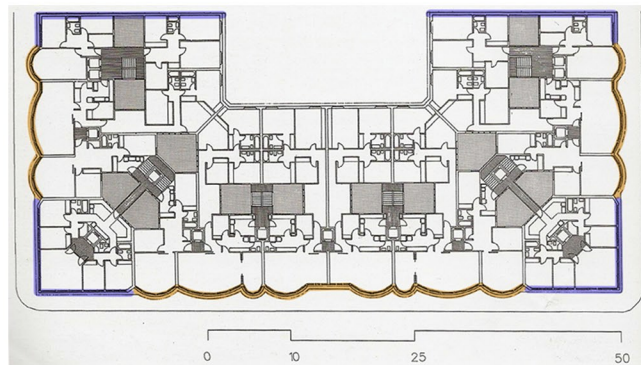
Planta modificada del edificio de viviendas Urumea por el alumno, muestra los dos recursos empleados en la elaboración de la fachada, ondulaciones perfiladas en las esquinas del ensanche
